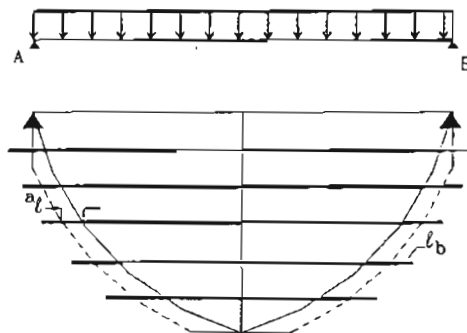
Detalhe de escalonamento da armadura da viga
